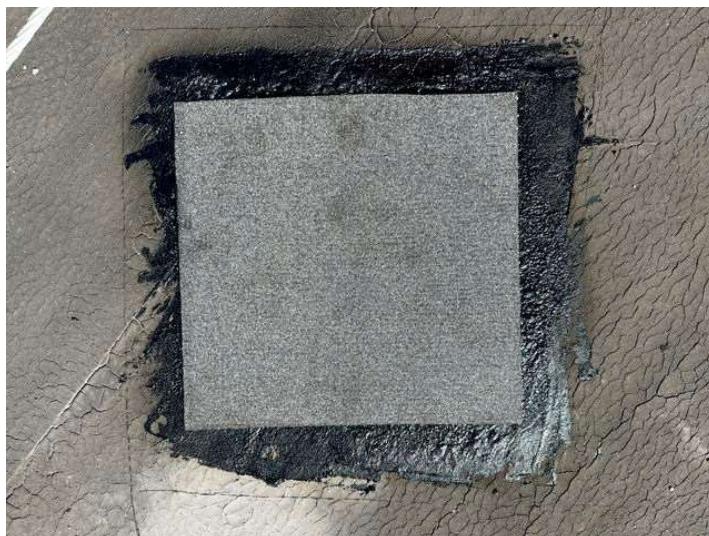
Pohled na zapravení sondy S2 – spodní pás
